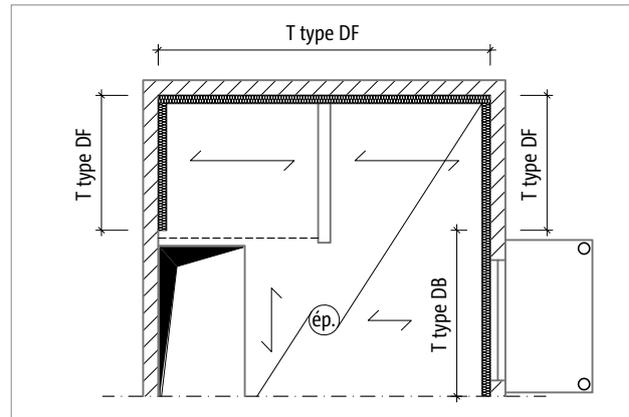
Schöck Rutherma® T type DF : utilisation entre la dalle et la façade
